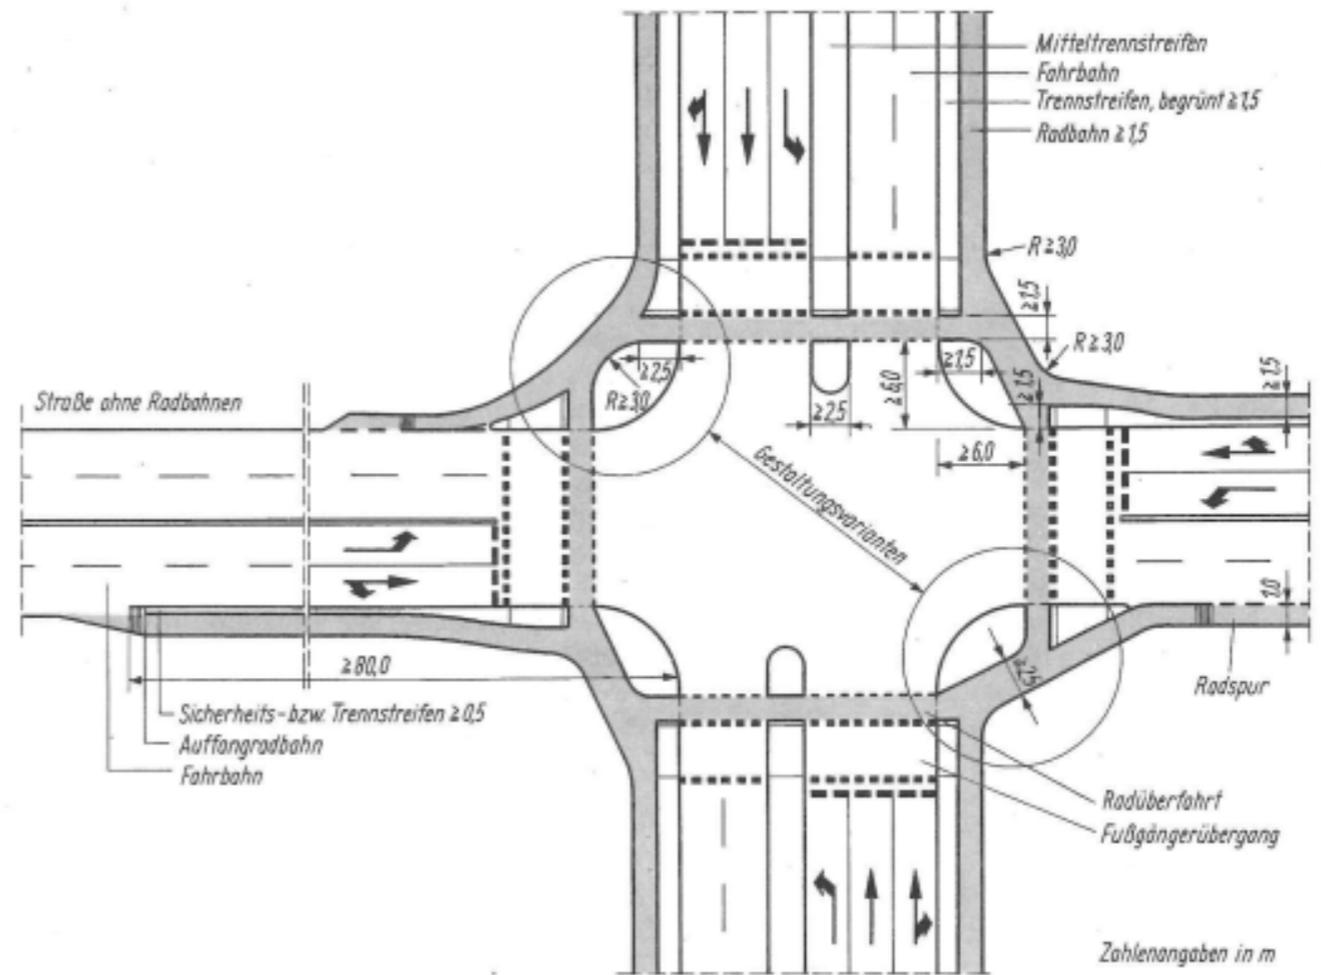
Führung des Radverkehrs an Straßenknoten mit dem Fußgängerverkehr (starre Schiene)
